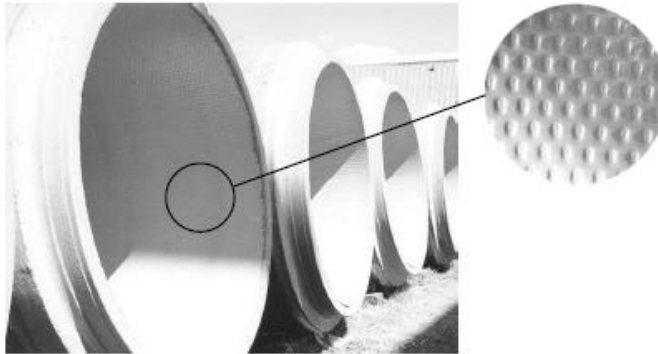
Tubo de concreto reforzado con junta hermética. Detalle de recubrimiento de polietileno de alta densidad.
